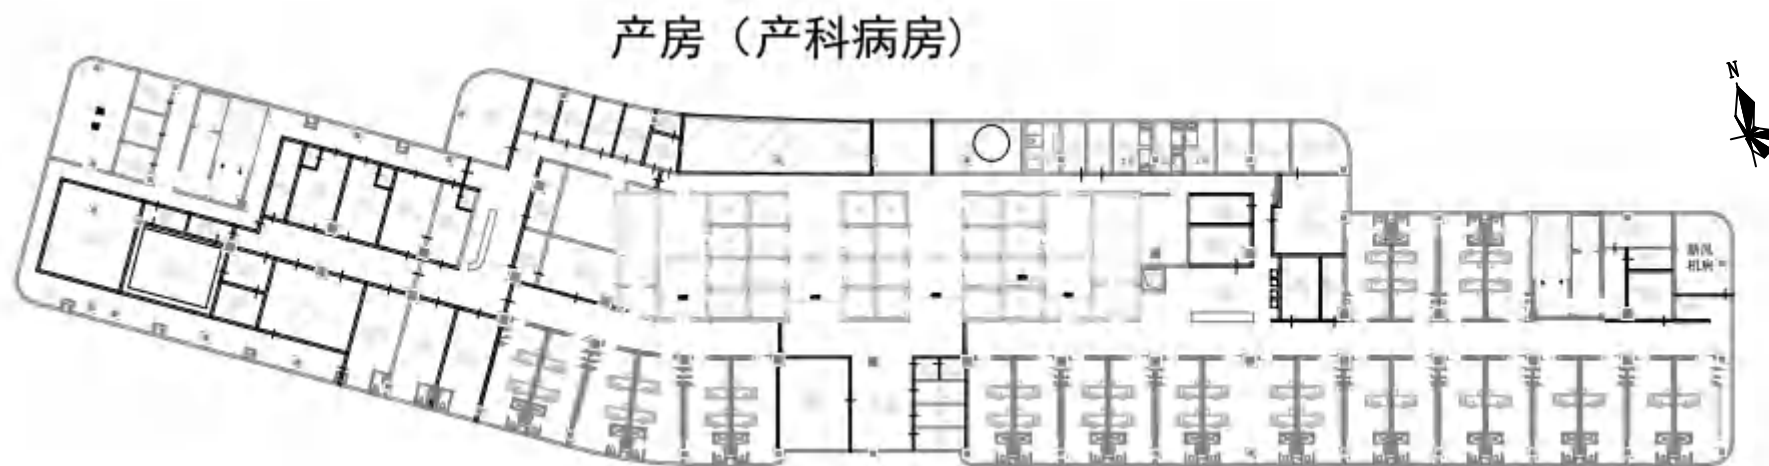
项目医疗综合楼六层平面布置图（比例尺：1:819）
